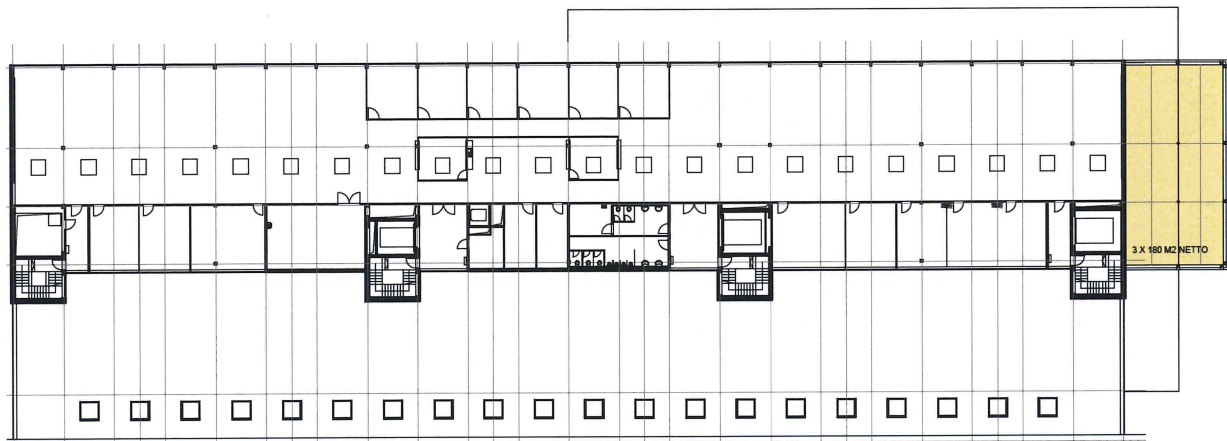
Variante 4 Grundriss 1. OG mit Anbau Seite Südwest
